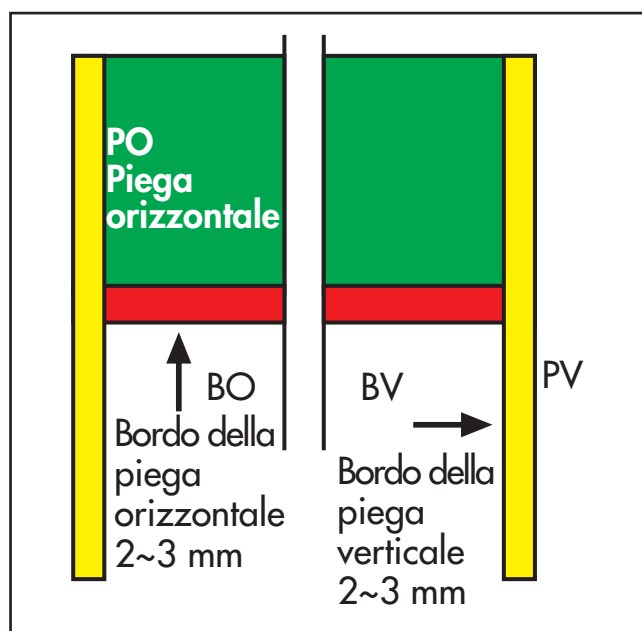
e) - Giunzione a 90° vista dall'alto: prevalenza della piega verticale
